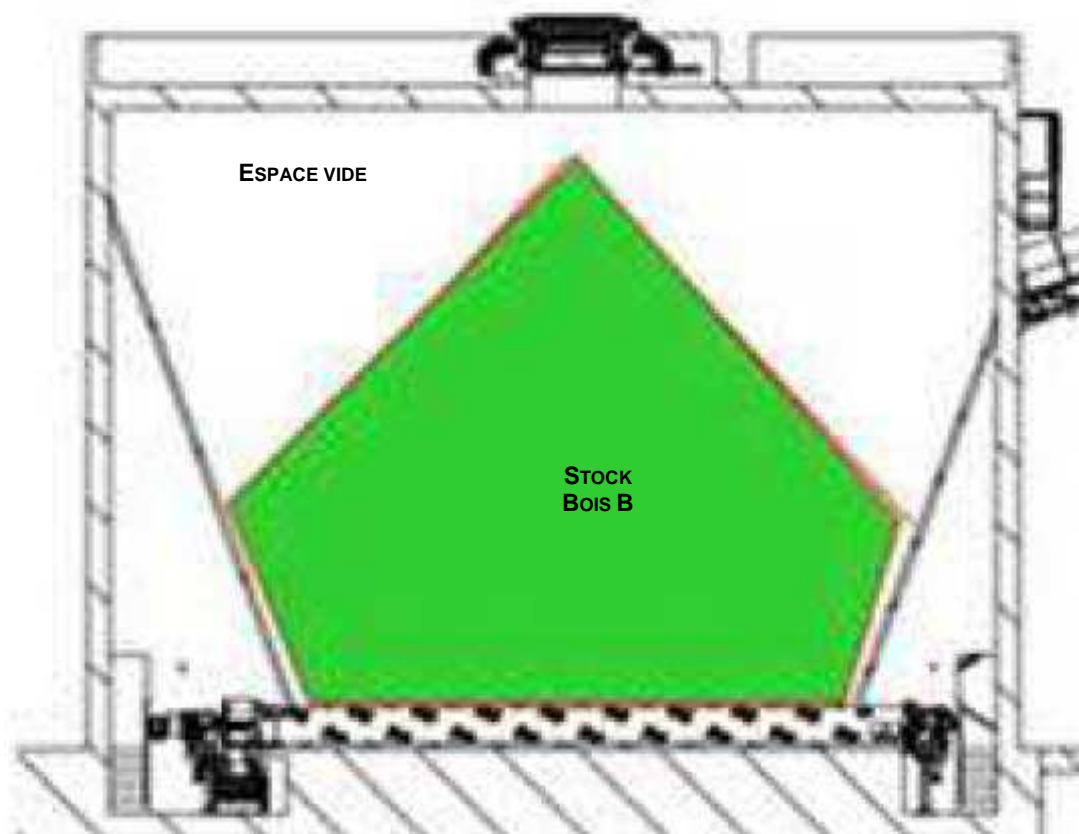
COUPE TRANSVERSALE DU SILO.
